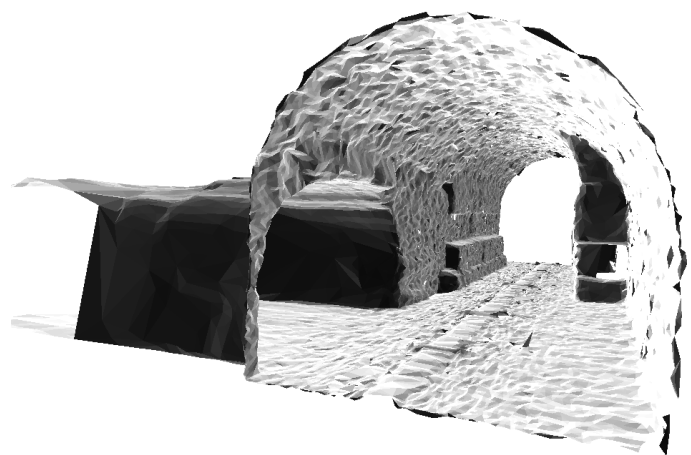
Pormenor do modelo 3D reconstruído em VRML
